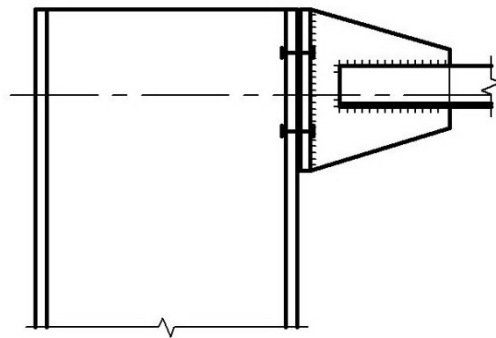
Вариант жесткой конструктивной схемы крепления верхнего узла ригеля к колонне
